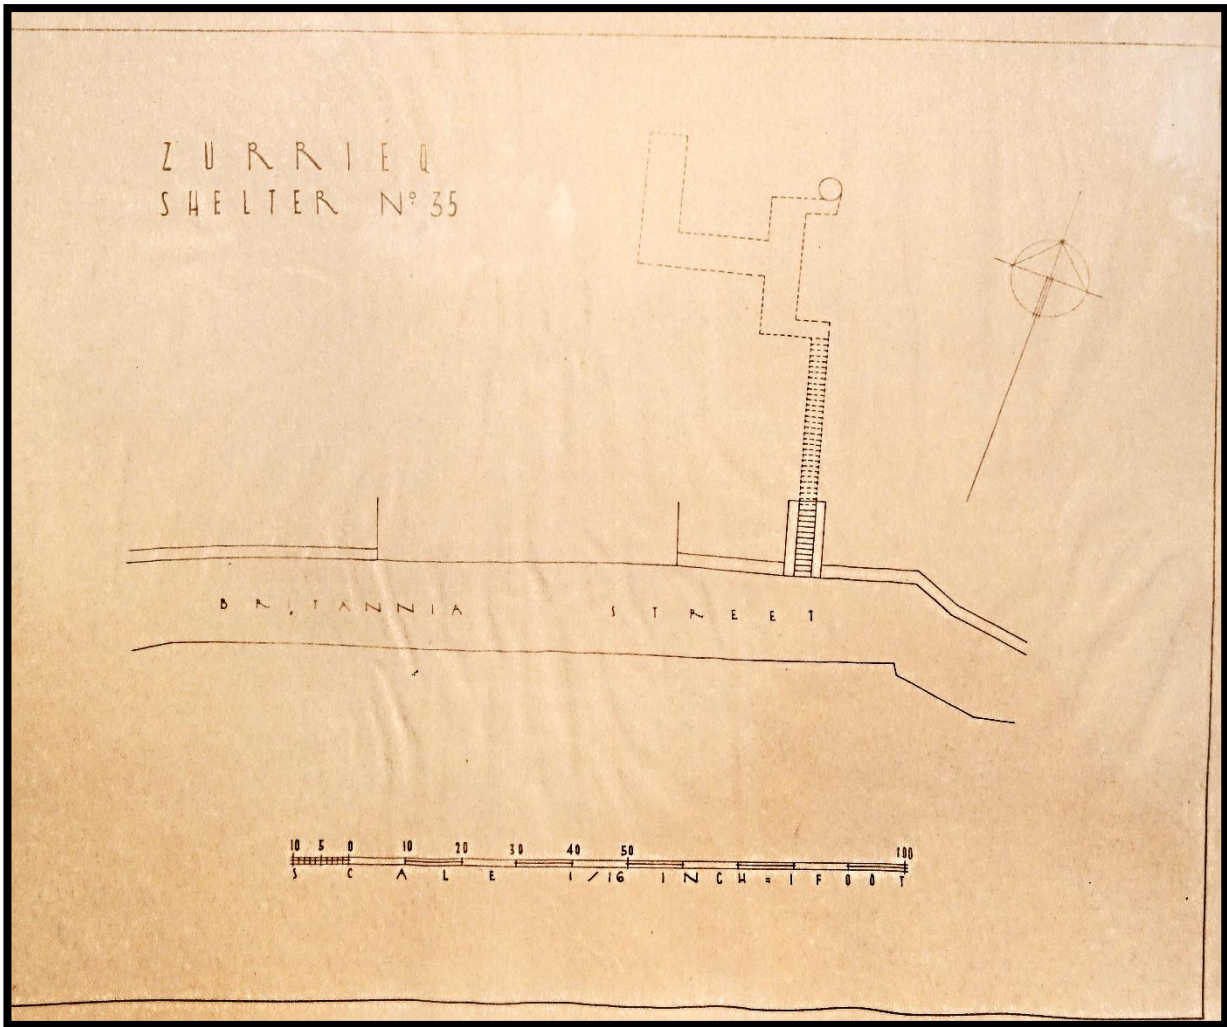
Planta do Abrigo nº35 "Britannia Street"
